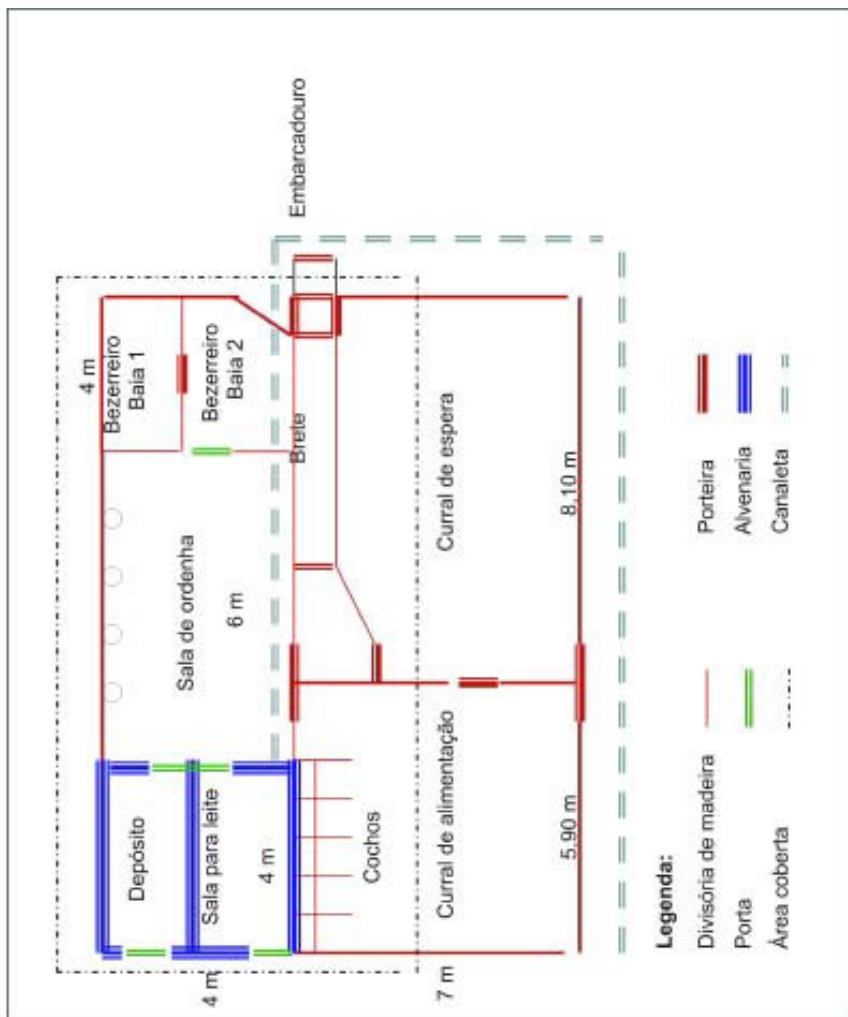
Planta de um estábulo com instalações para manejo de rebanho leiteiro.
